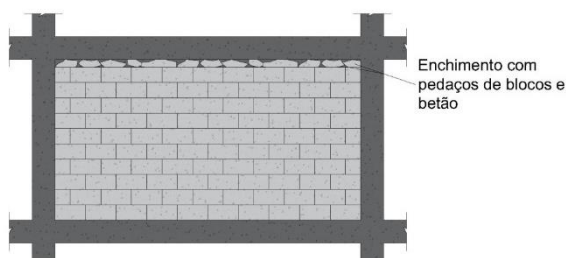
Enchimento de espaço vazio entre parede de alvenaria e pórtico com pedaços de blocos e argamassa.
